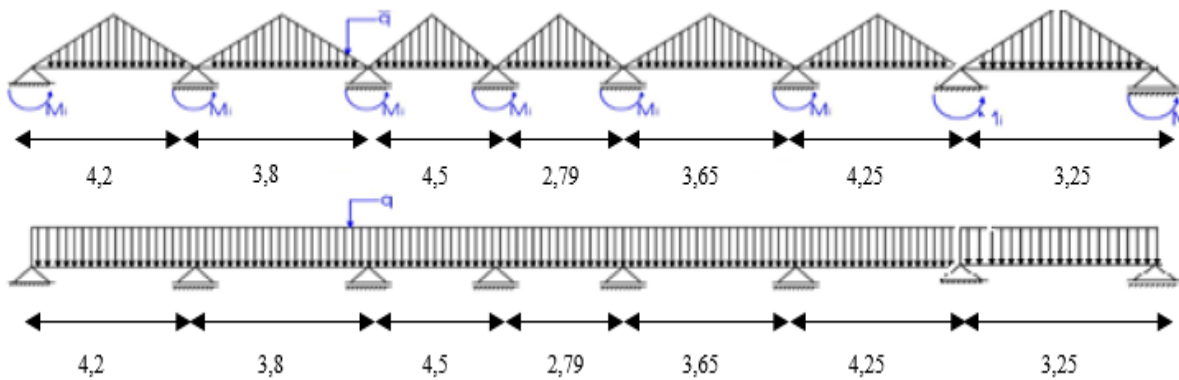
Distribution des charges sur les poutres secondaires.
